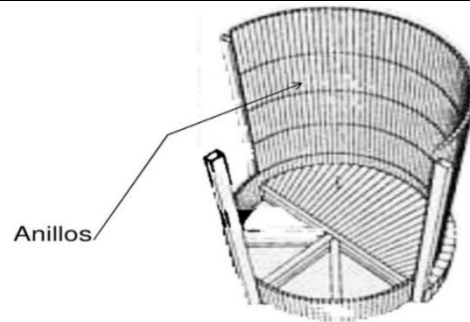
Construcción de lumbreras con anillos prefabricados (Paulin, 2010).
